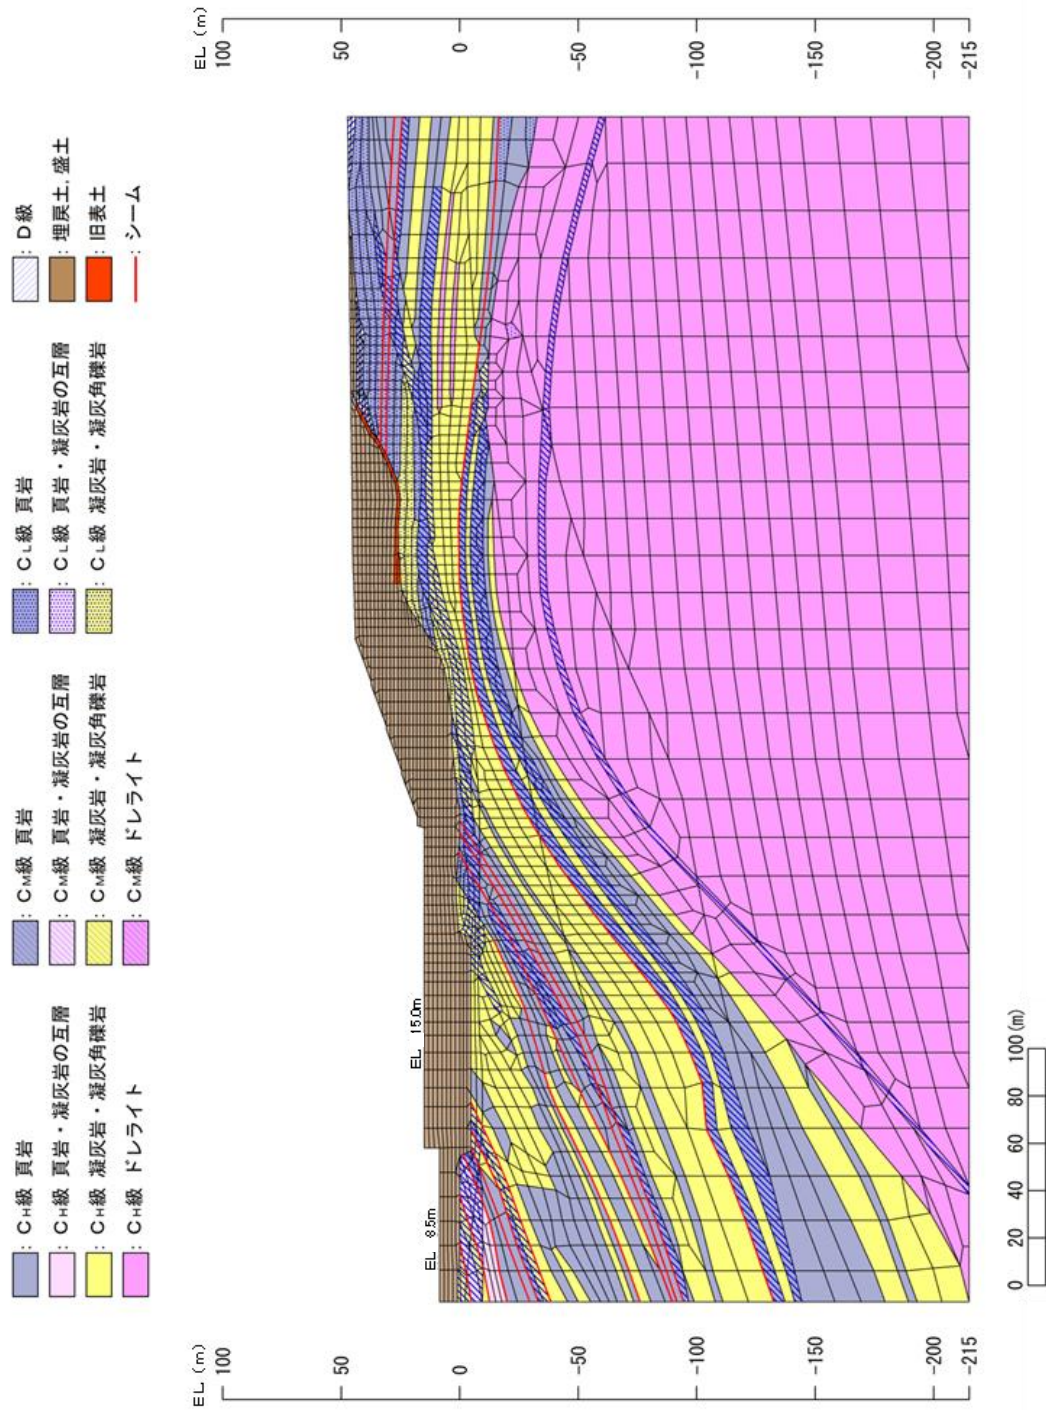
解析モデル図 (⑧-⑧' 断面)
